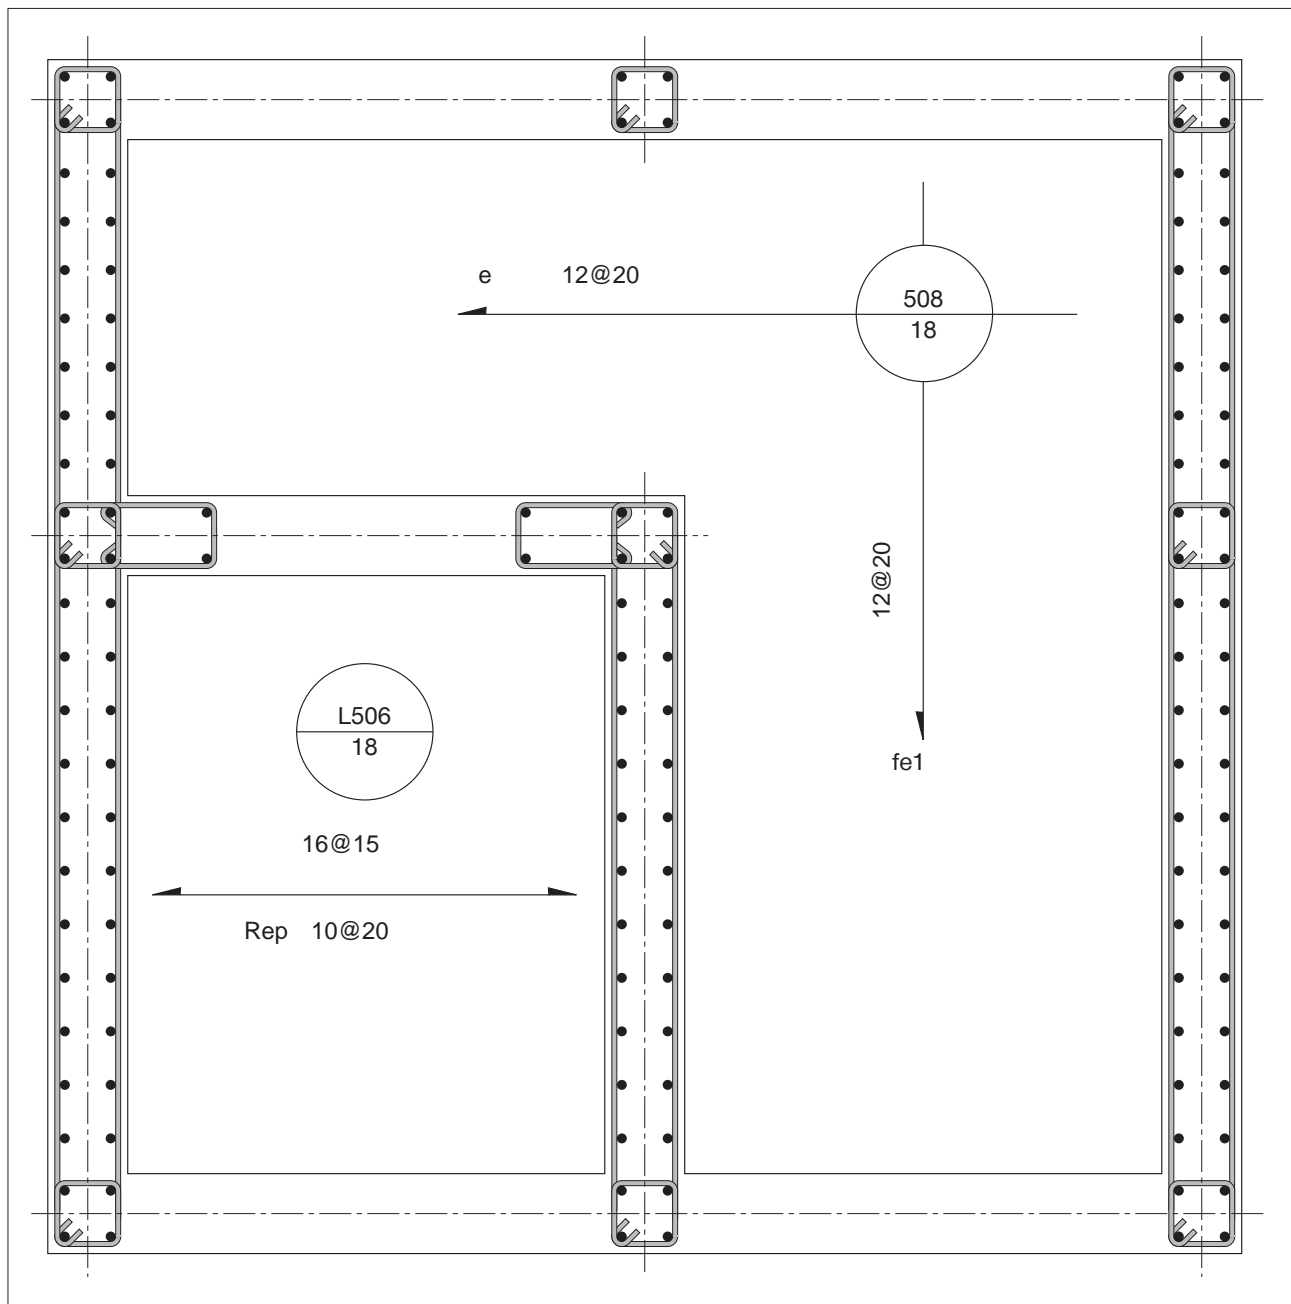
Plano de Conjunto Losas 506 y 508 (fuera de escala).
